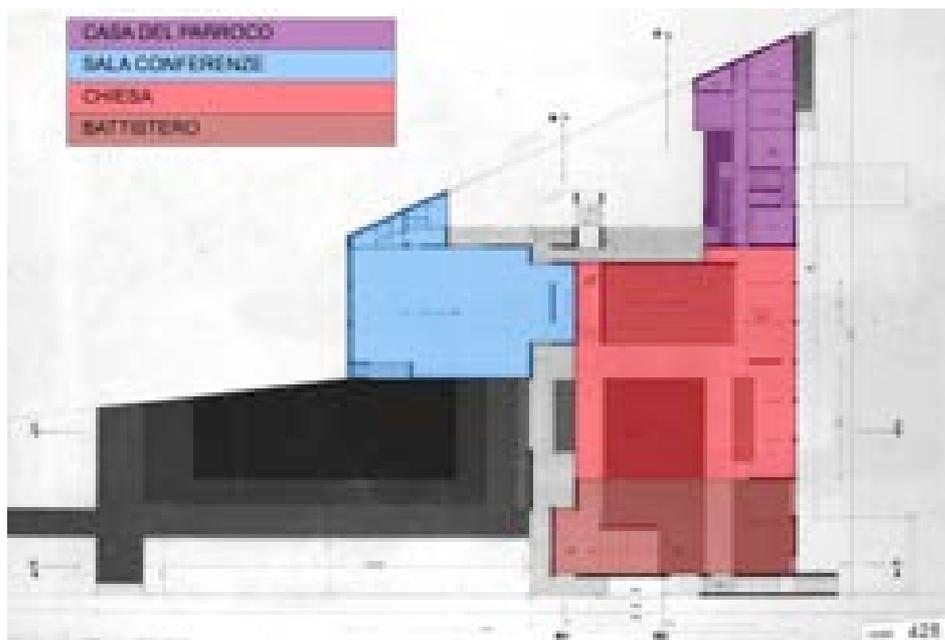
Rielaborazione pianta +5.60 – 15/01/1977 (AABS-1996.428)
